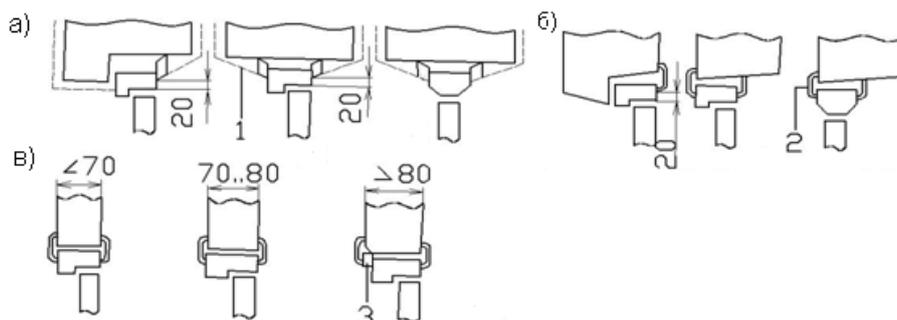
Примеры установки дверных блоков в стенах и перегородках:
